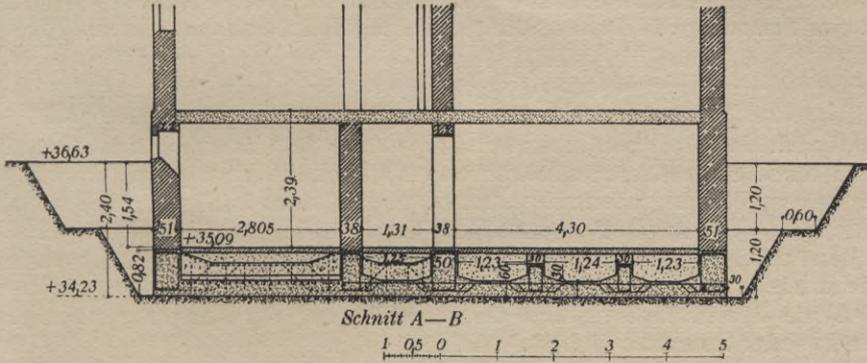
Gründung eines freistehenden Wohnhauses auf eine Eisenbetongrundplatte.
